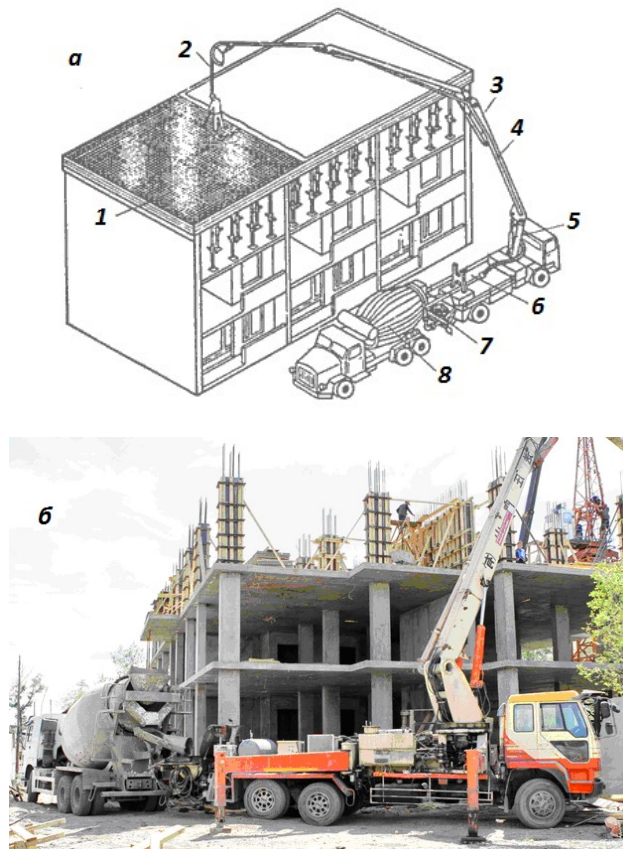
Подача бетонної суміші автобетононасосом: а – технологічна схема; б – загальний вигляд; 1 – гнучкий рукав; 2 – шарнірно-зчленована стріла; 3 – бетоновод; 4 – гідроциліндр; 5 – бетононасос; 6 – приймальний бункер насоса; 7 – автобетонозмішувач
